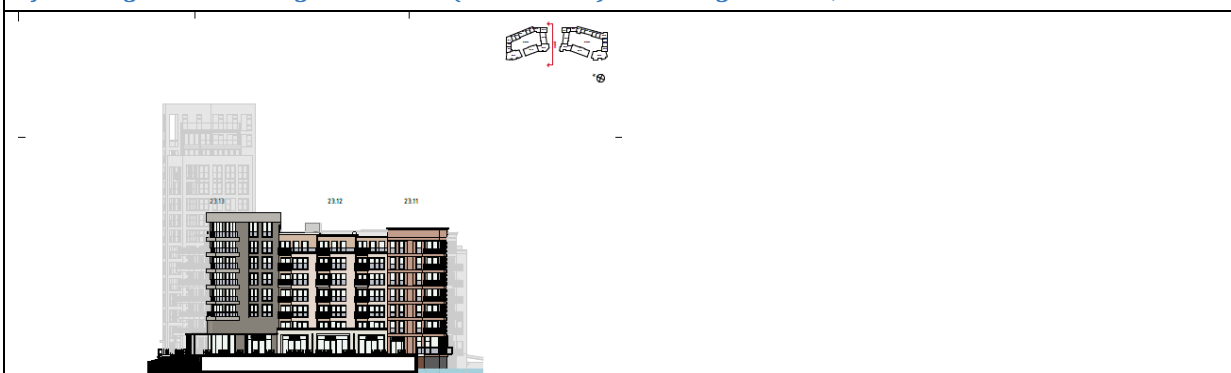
C: Noordgevel Blok 22 (en Toren 22) – tekening nr. 121b, d.d. 23-3-2017
